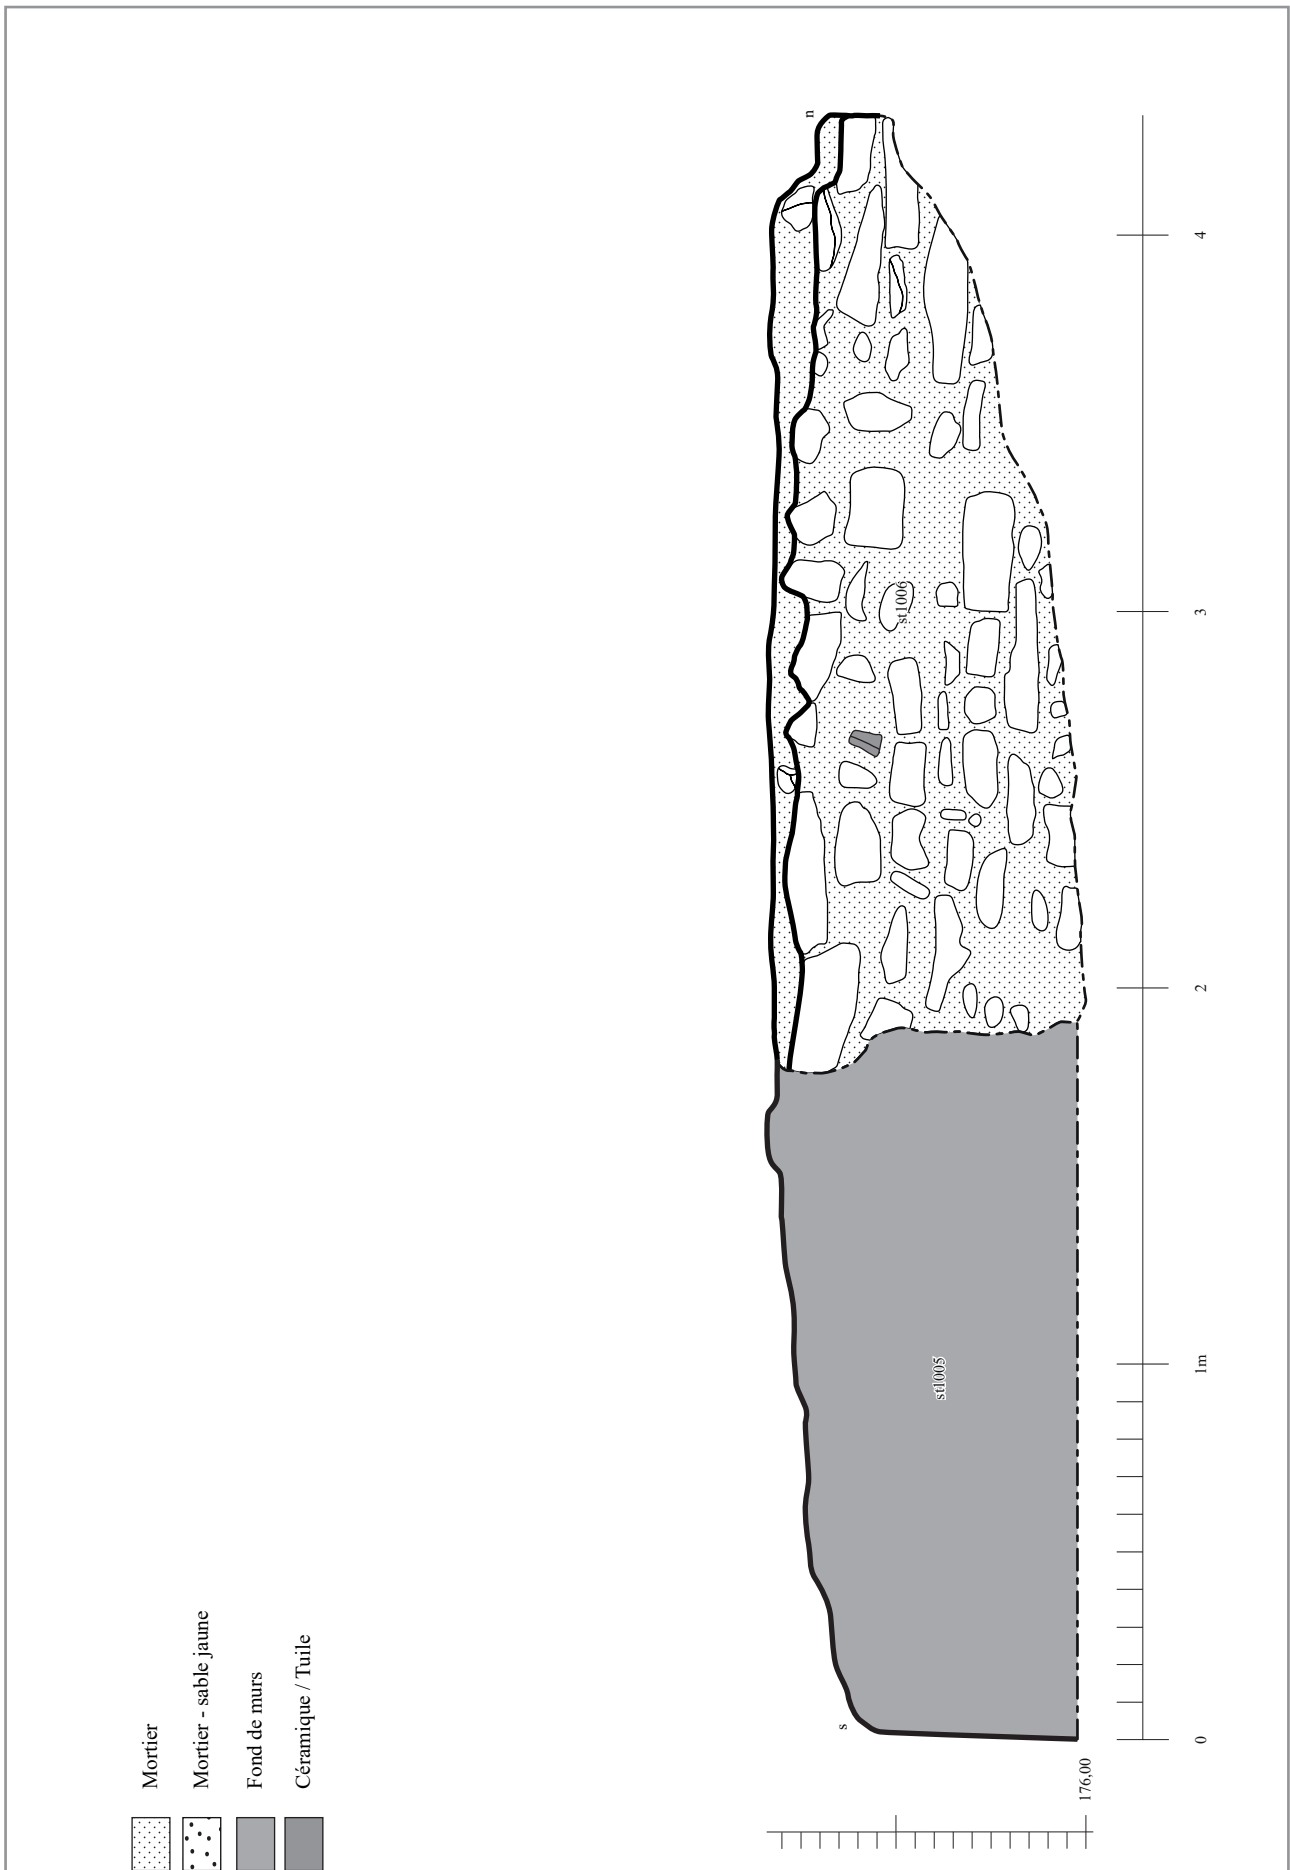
Parement est du mur 1006 (échelle : 1/20 ; DAO : N. Lenôtre).
